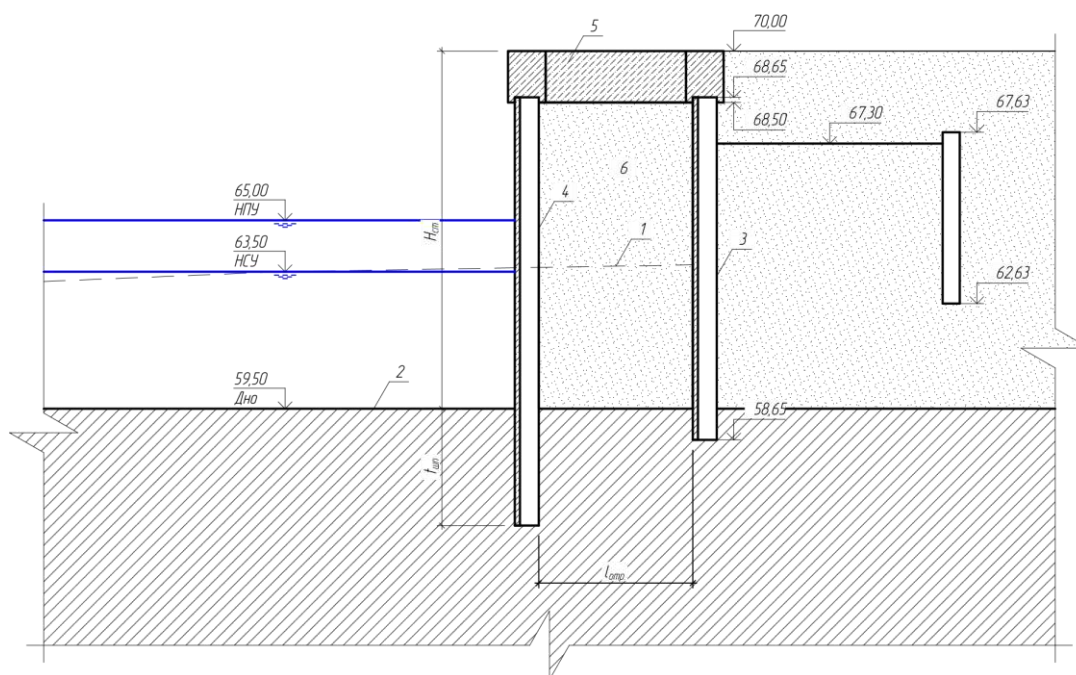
Схема реконструкции причальной стенки путем устройства заанкеренного больверка [3]
